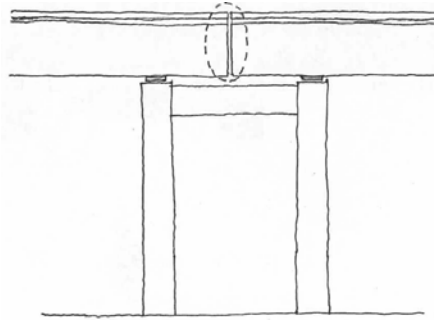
Condizioni di appoggio dell'impalcato sull'infrastruttura.
